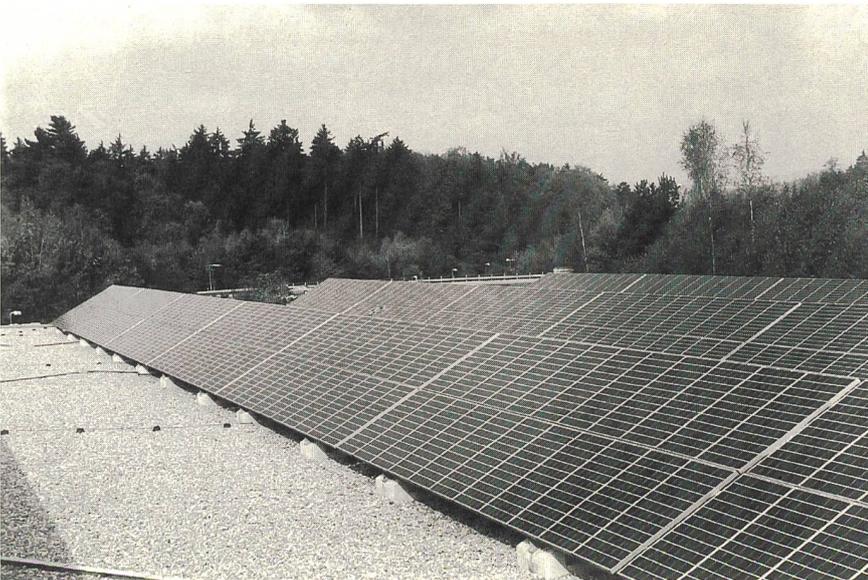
Dachgeschoss «Park+Ride» mit Solarzellenanlage.
